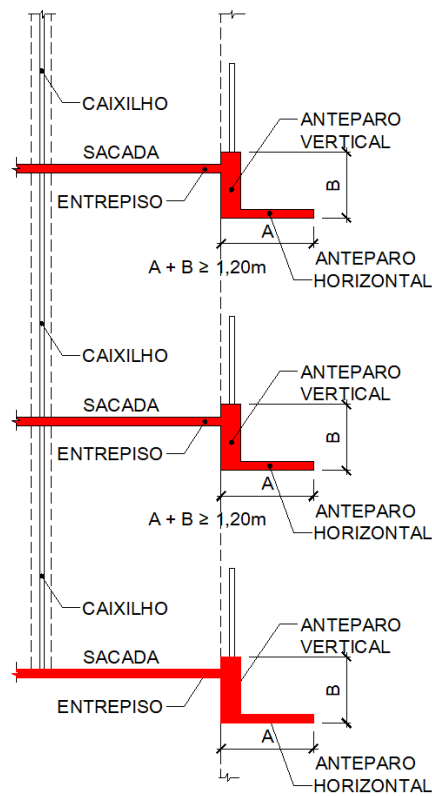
Compartimentação Vertical (Medição Entre Aberturas a Partir da Extremidade da Sacada e Somatório dos Elementos Construtivos Verticais e Horizontais)
